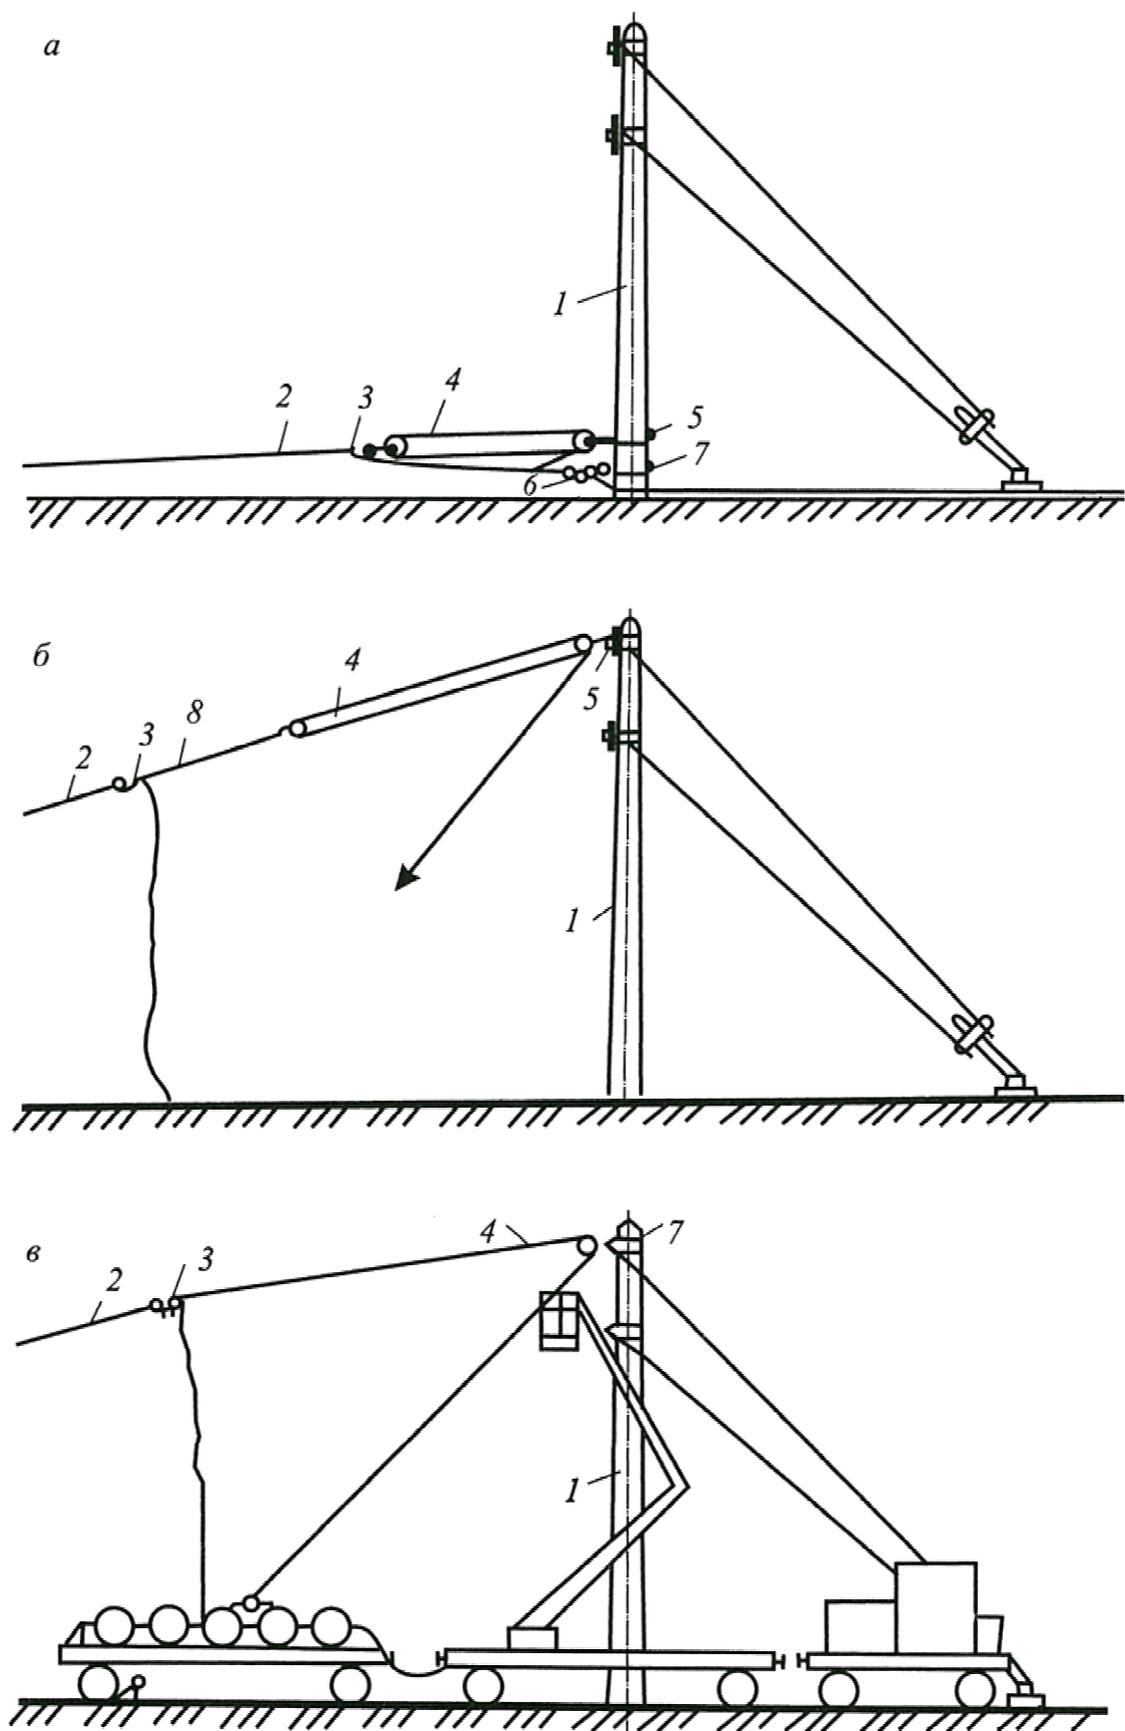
Схема монтажа жесткой анкеровки несущего троса
